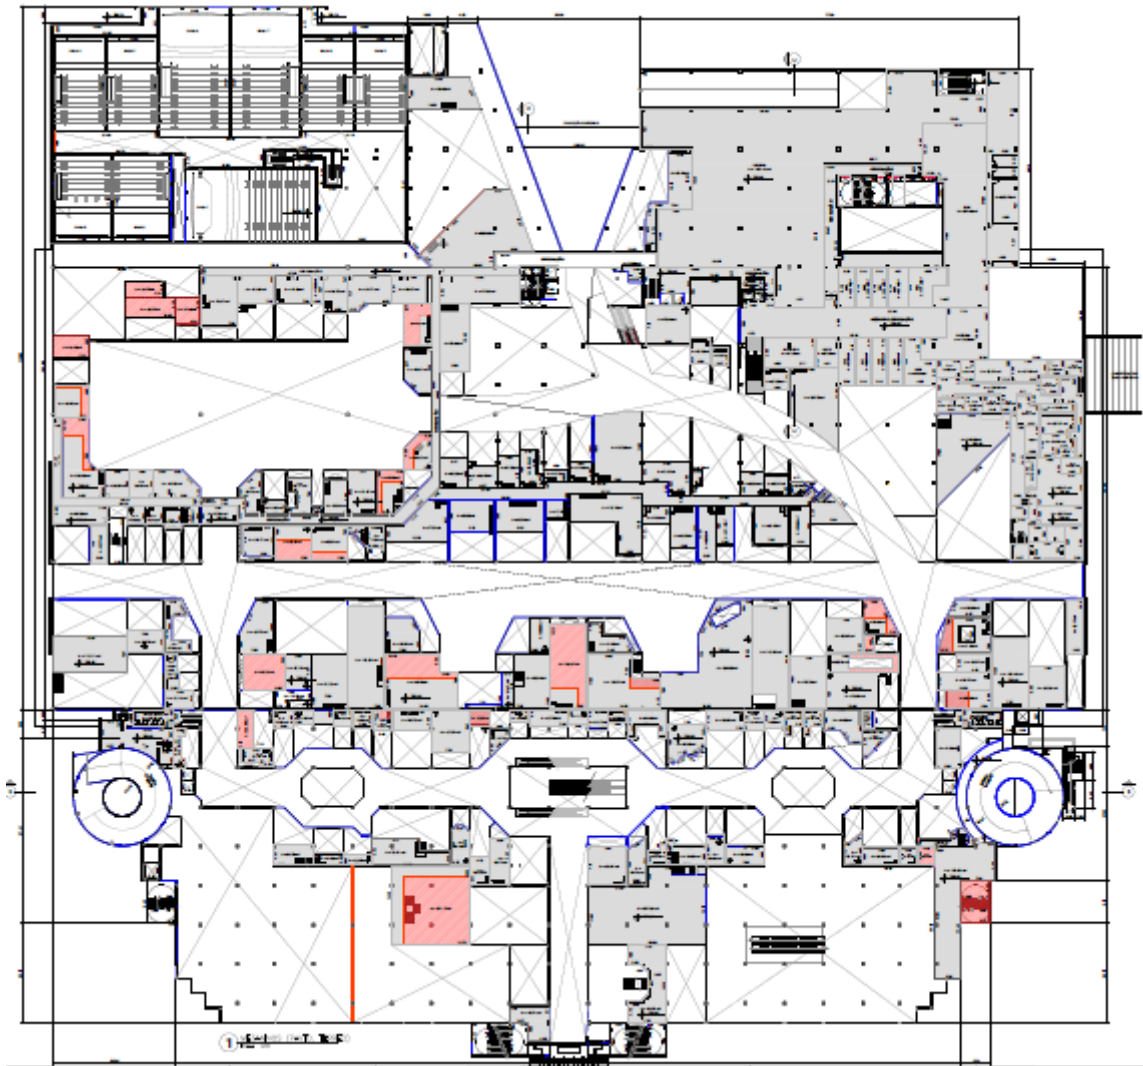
Planta Mezanino. Fonte: Engexpor.
